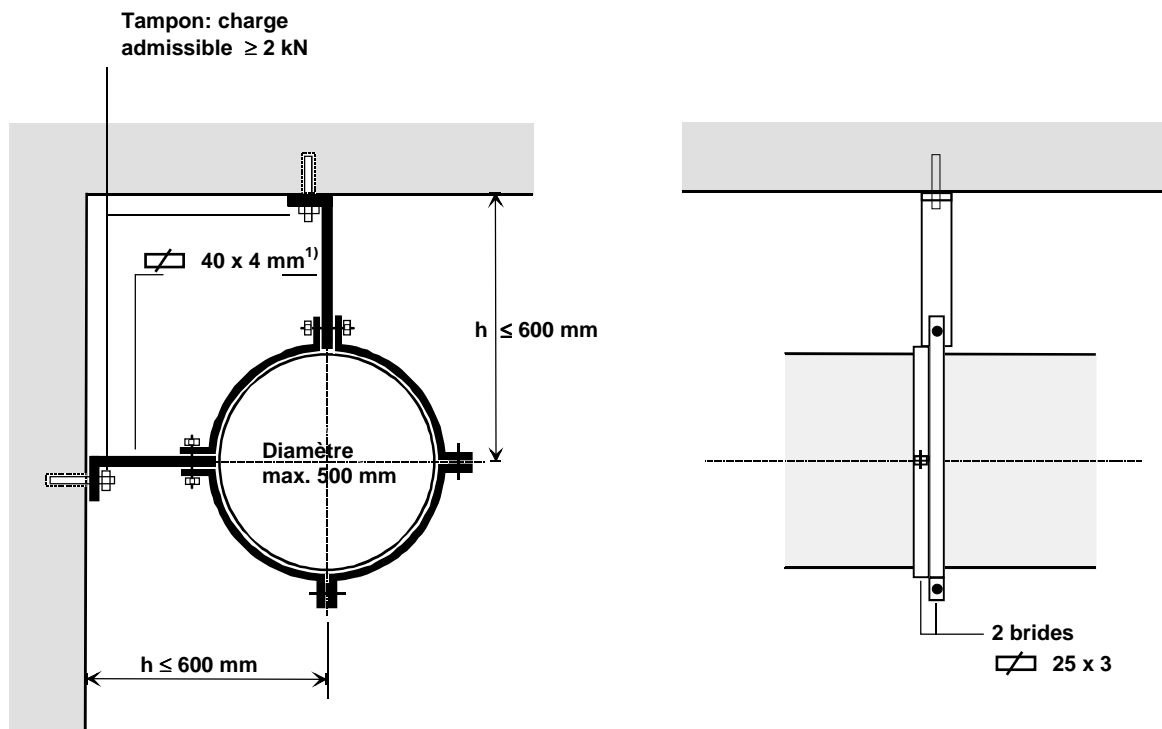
Fixation d'une conduite d'air sur entretoise latérale (2 brides)
